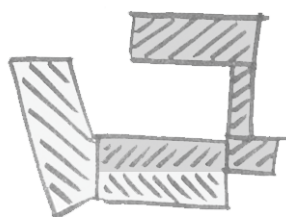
Impianto planivolumetrico con divisione delle zone di privato e pubblico.
